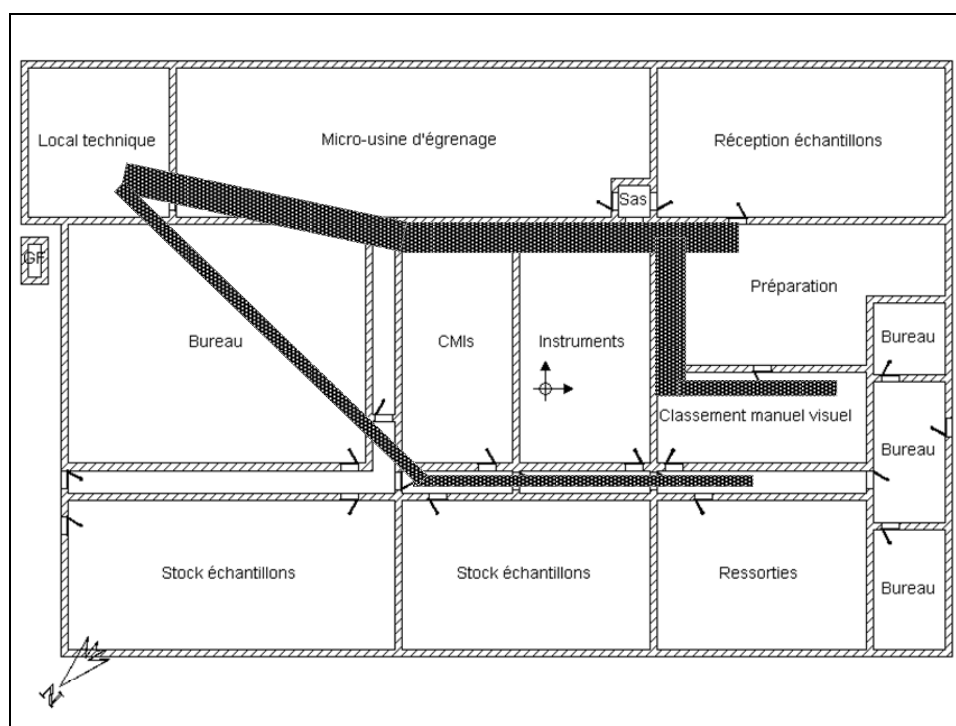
Plan approximatif intégrant les conduites d'air depuis la centrale de traitement d'air vers les salles d'analyses, conduites installées entre le toit et la dalle de plafond des laboratoires.
